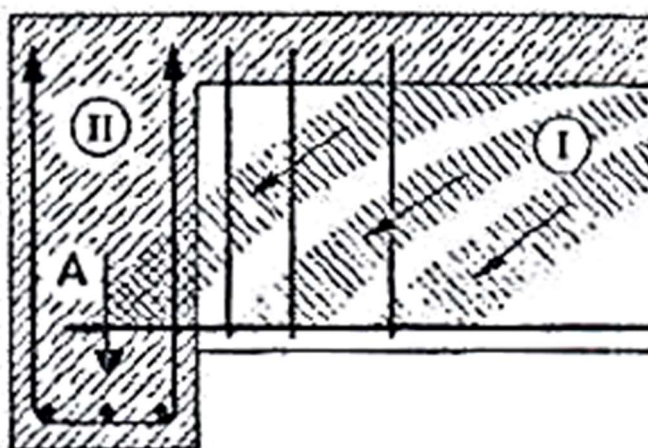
Tipos de ligações de apoio indireto para viga suporte em balanço
